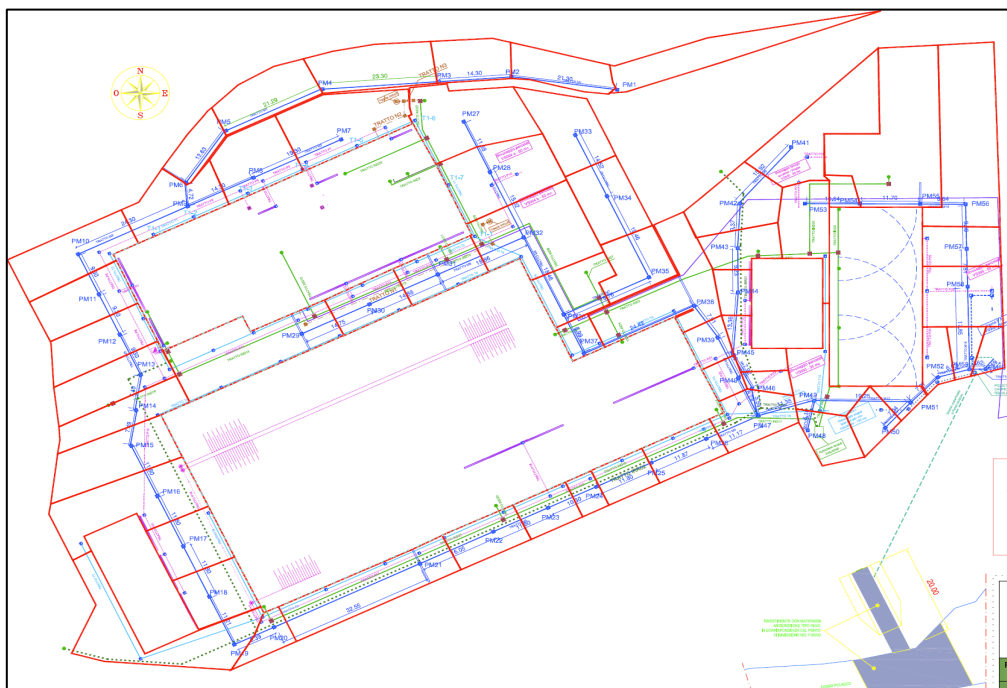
Stralcio planimetrico con indicazione delle aree scolanti considerate
